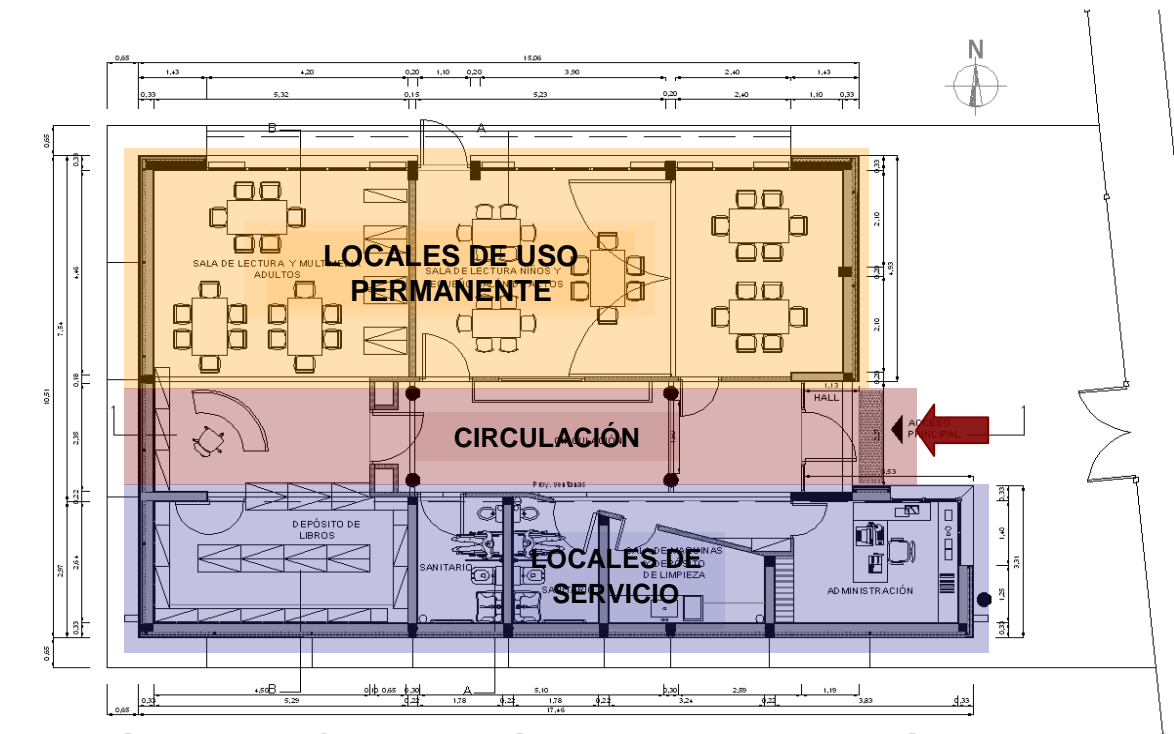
Imagen zonificación en plano de planta biblioteca pública Lavalle
